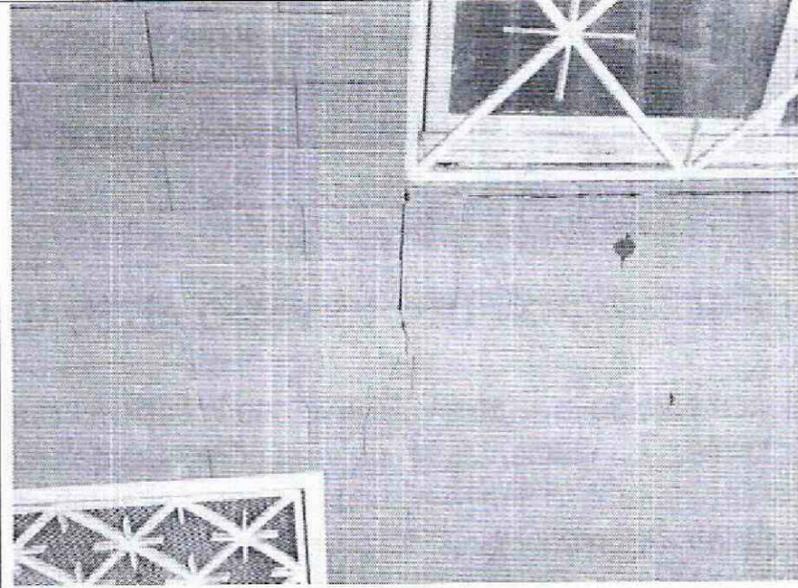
Fisuras en muro de fachada del primer piso.
